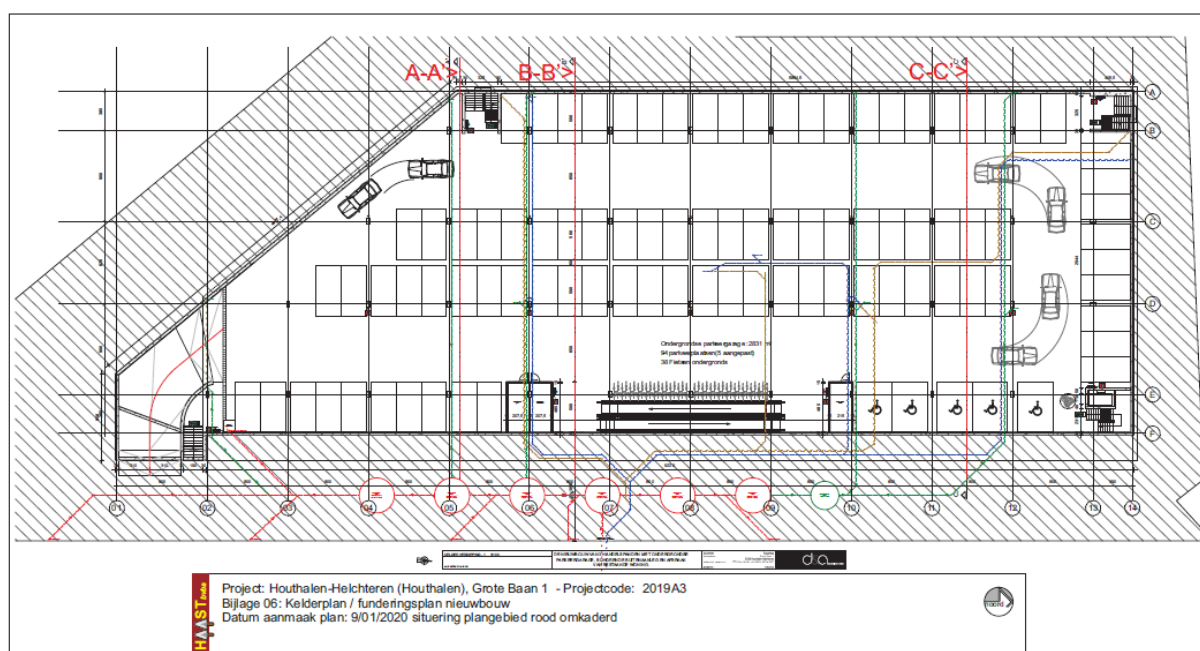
Kelderplan en plan hemelwateropvang van de nieuwbouw en detail van de infiltratieputten zoals aangereikt
